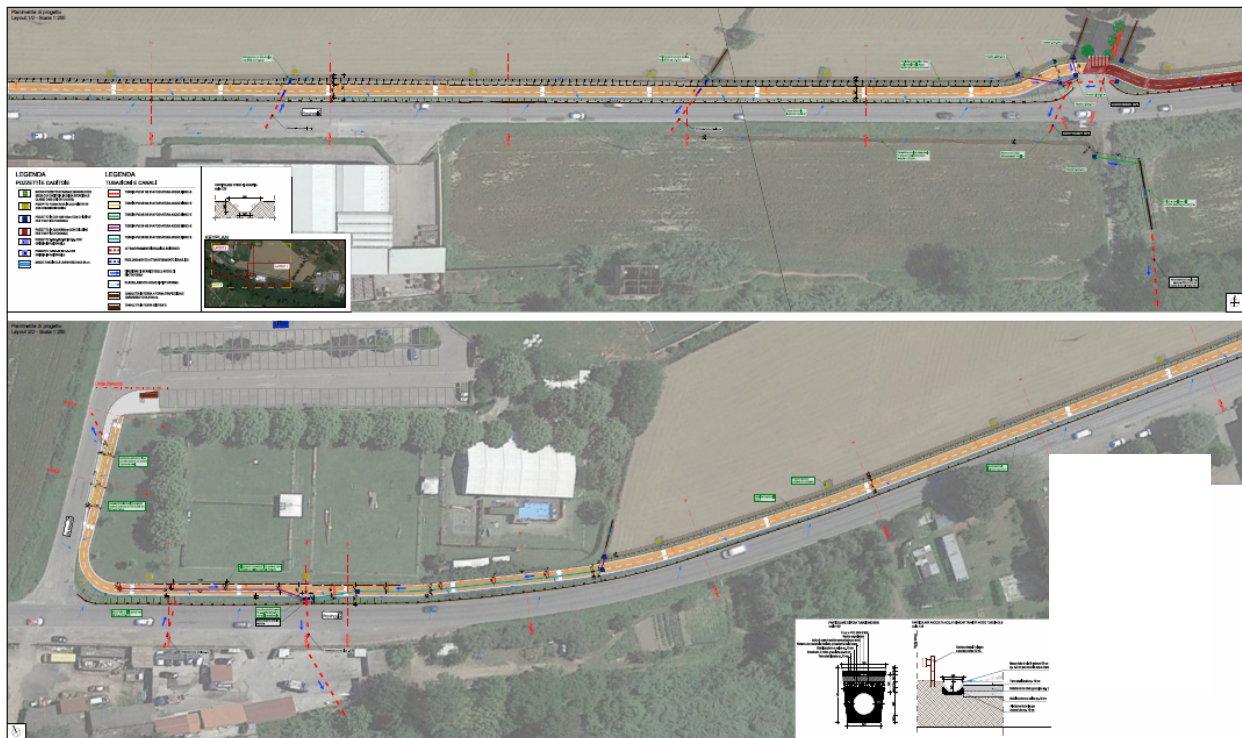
Estratto planimetria di sistemazione idraulica – Lotto 3
